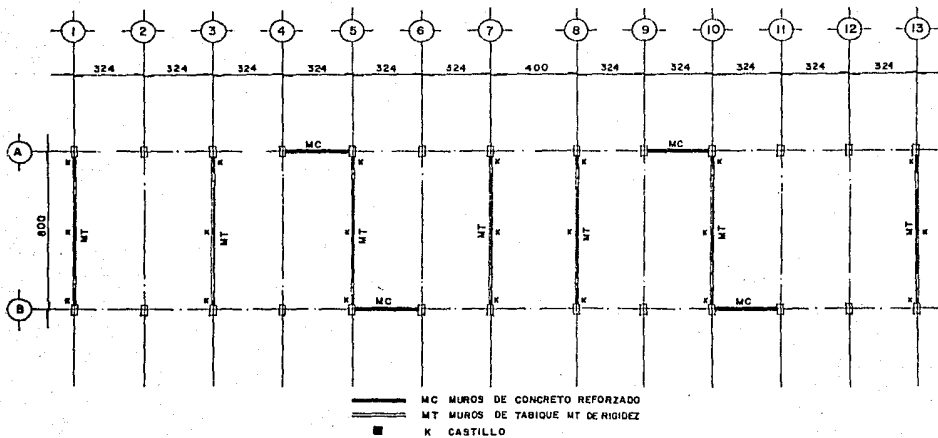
I. PROPOSICION DE RIGIDIZACION CON MUROS DE CONCRETO LONGITUDINALES Y MUROS TRANSVERSALES DE TABIQUE ROJO RECOCIDO.
